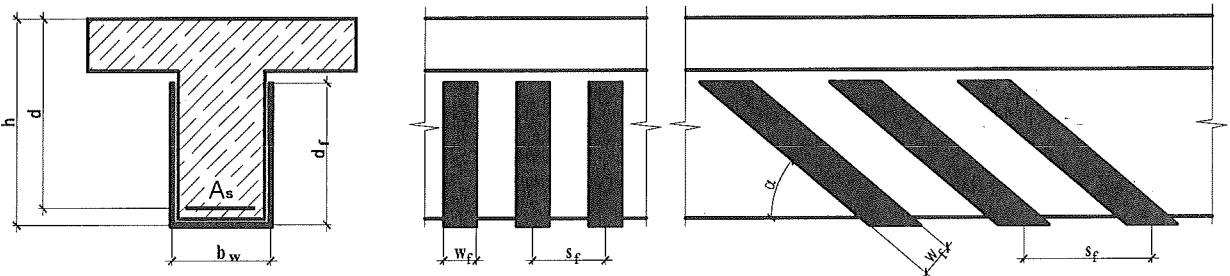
Размещение СВА FibARM хомутов для усиления наклонных сечений
